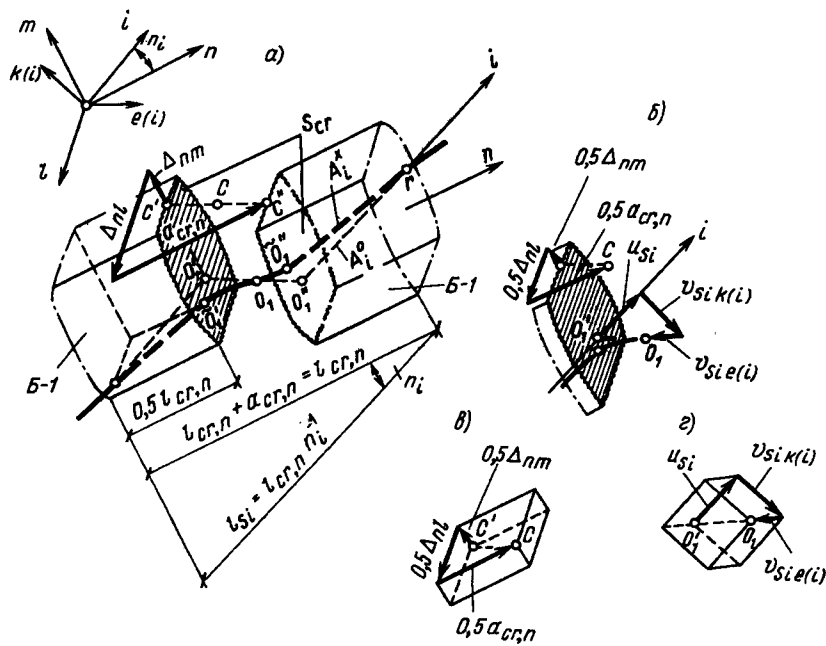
Перемещения арматурного стержня в наклонной трещине (а-г) и на участках между трещинами (а)
